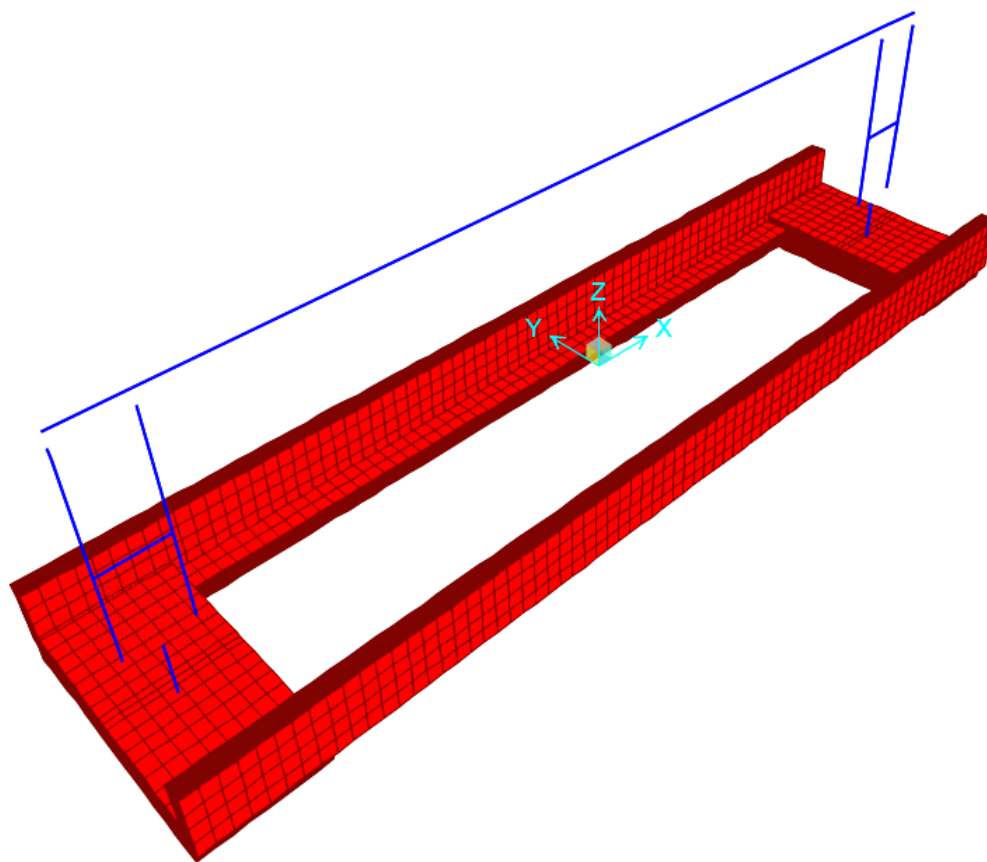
Modello 3D – Fondazione pensilina Centrale B=3,5m
